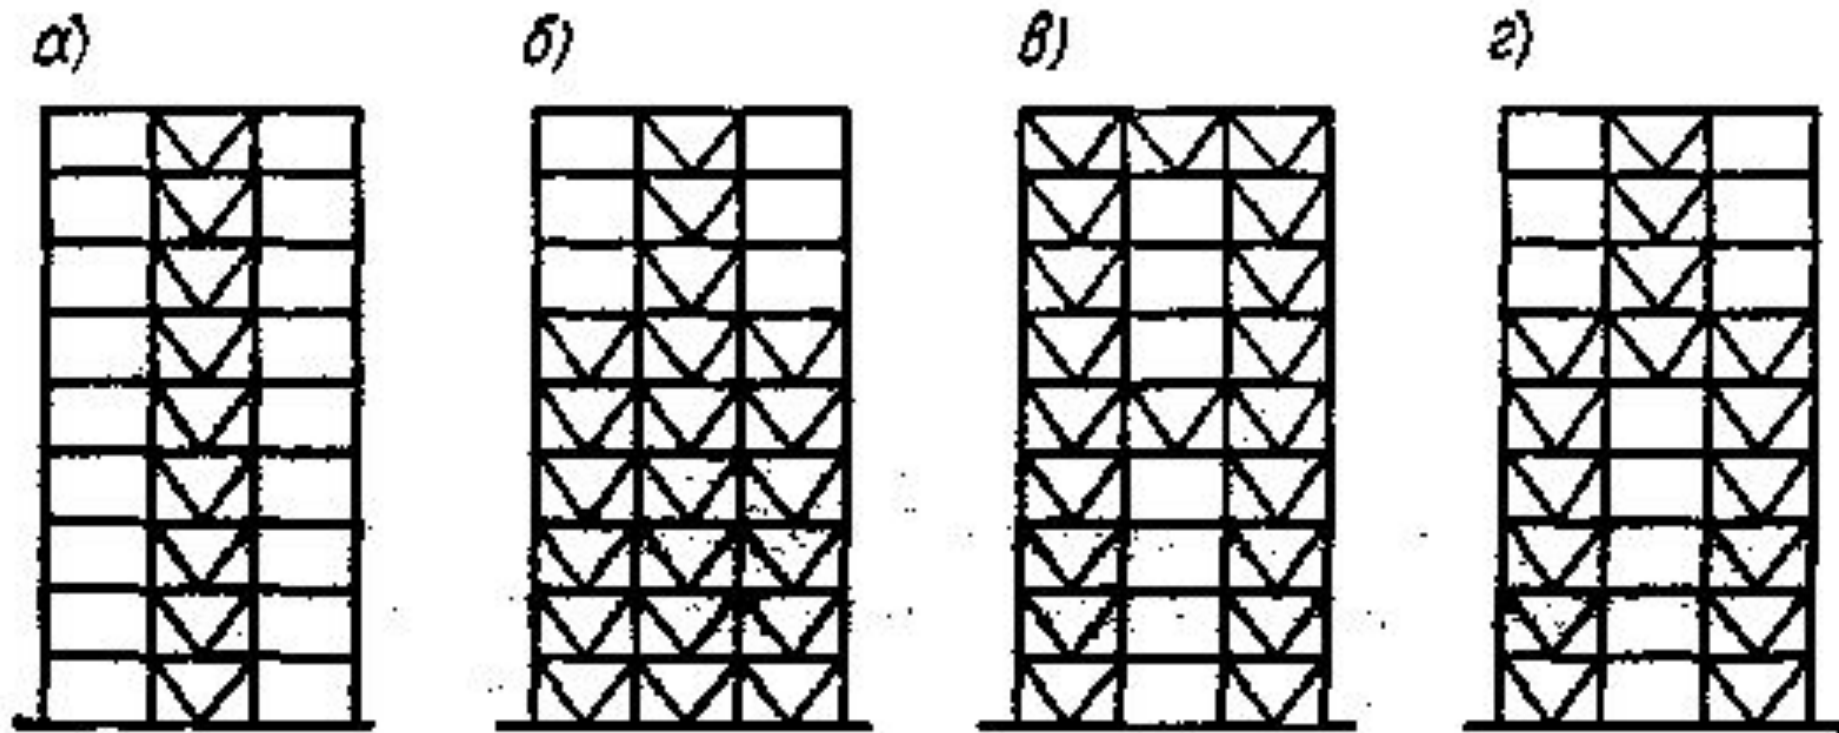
Схема каркасной железобетонной диафрагмы:
